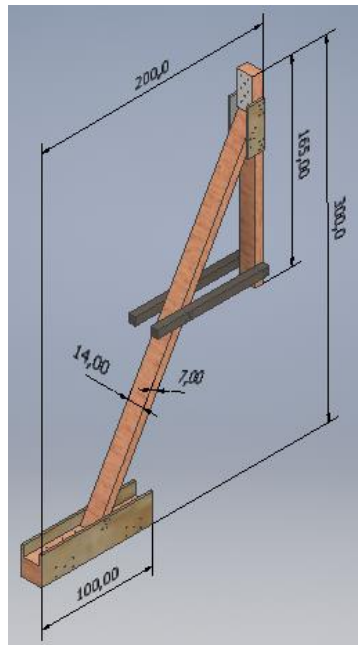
Dimensiones del apuntalamiento inclinado a fricción
